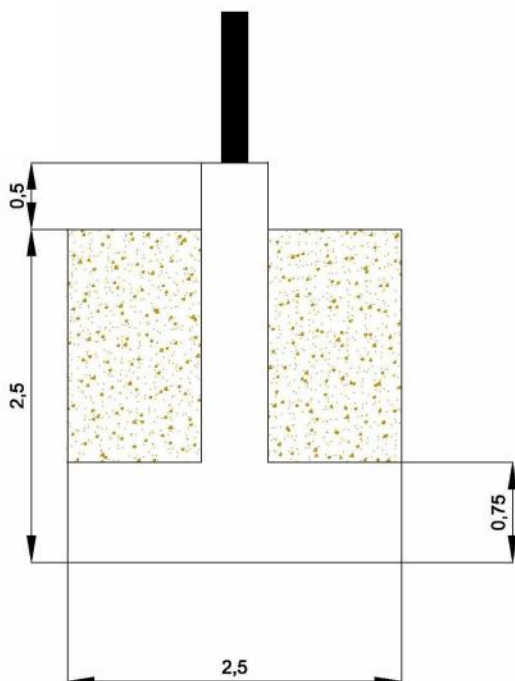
Serbatoi ST209 e ST210 – Geometria di progetto della fondazione ad anello
